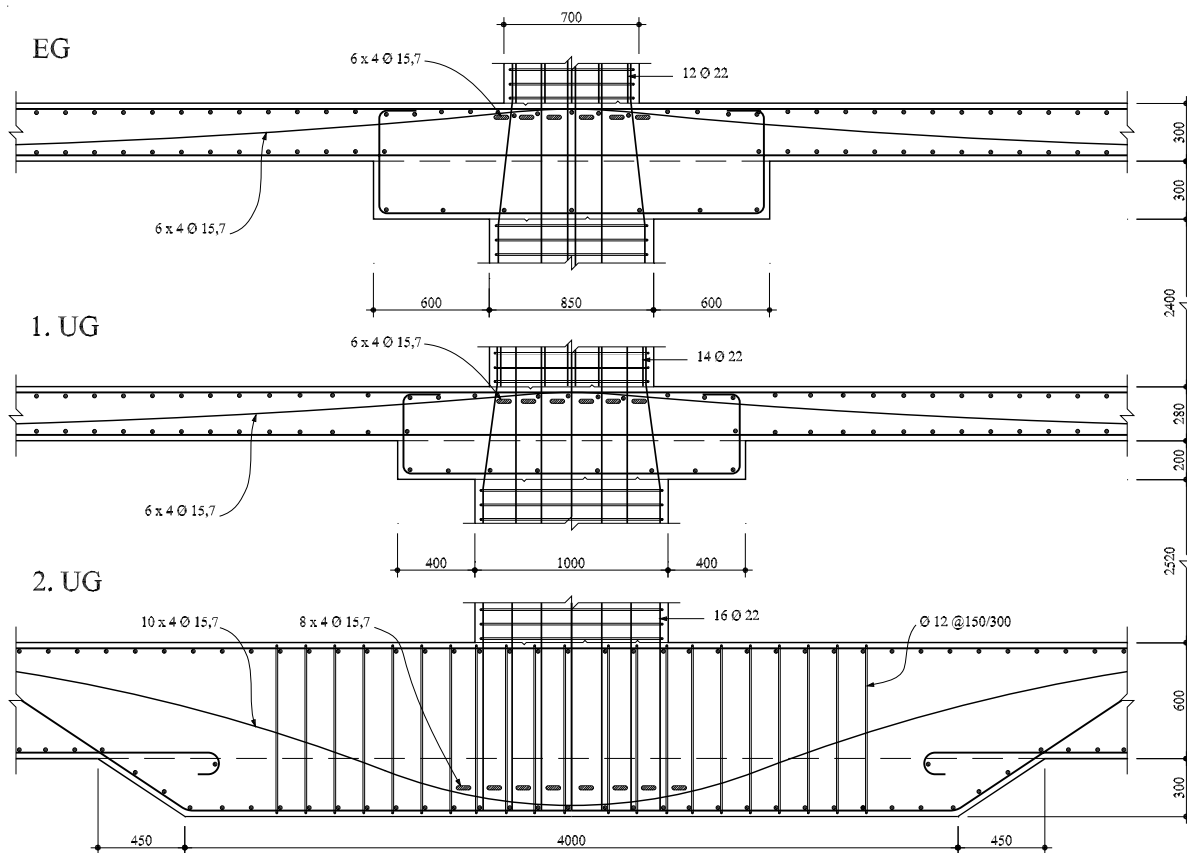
Schnitt I-I (Abmessungen in mm)
